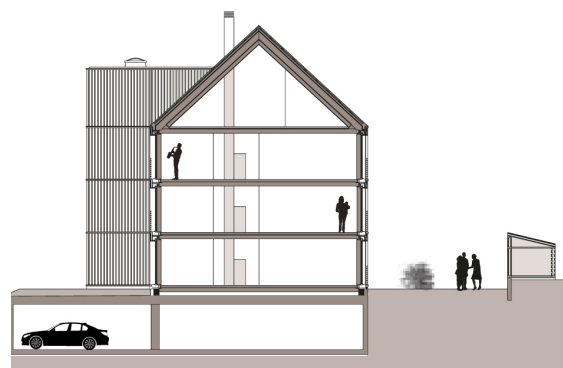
Sezione trasversale; Fonte: www.720grad-architekten.ch
